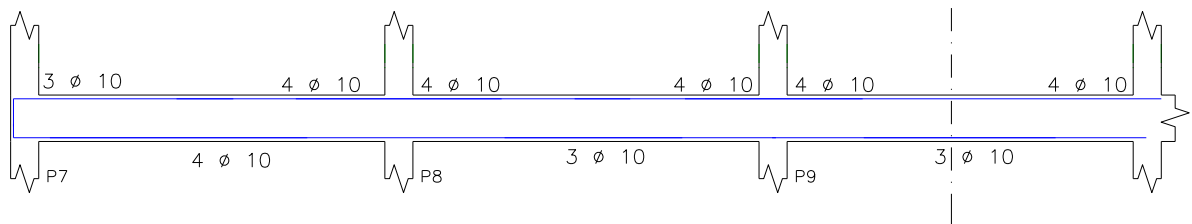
Esquema do dimensionamento à flexão das vigas finais 02/03/04/05/08/09/10/11, pavimento cobertura
